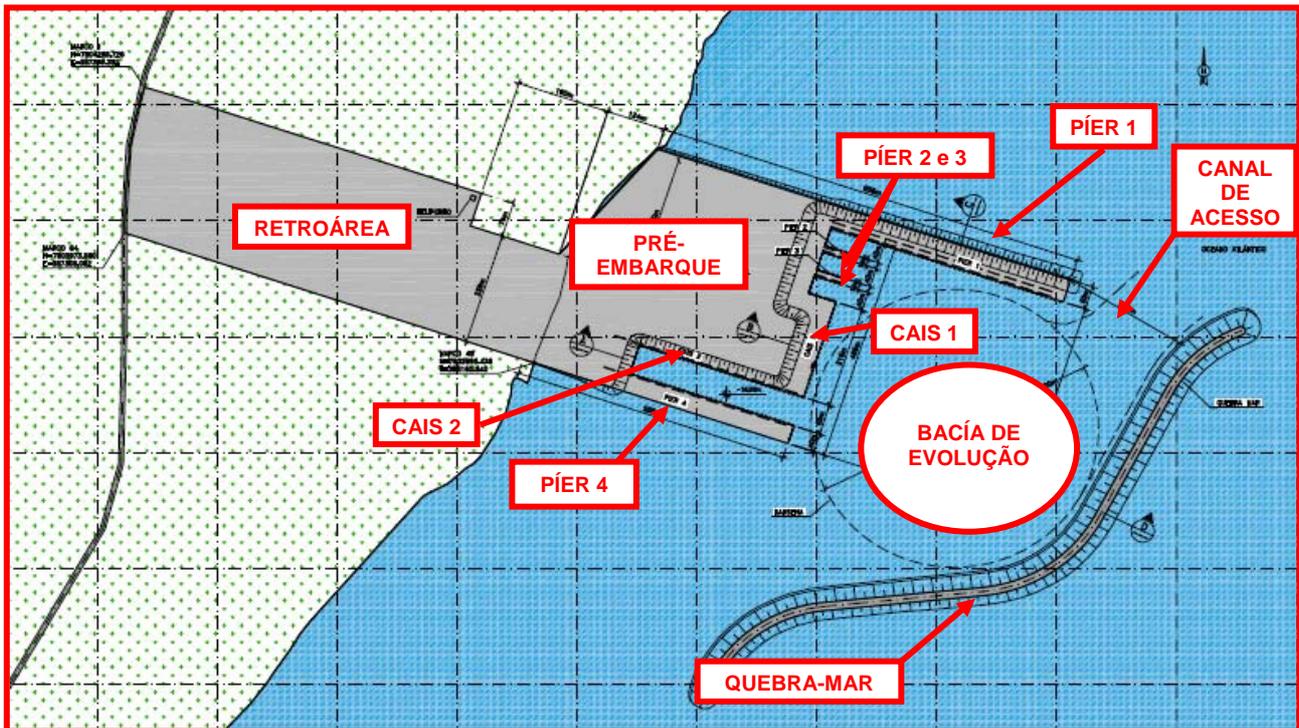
Detalhe das estruturas previstas para o Terminal Industrial IMETAME.
